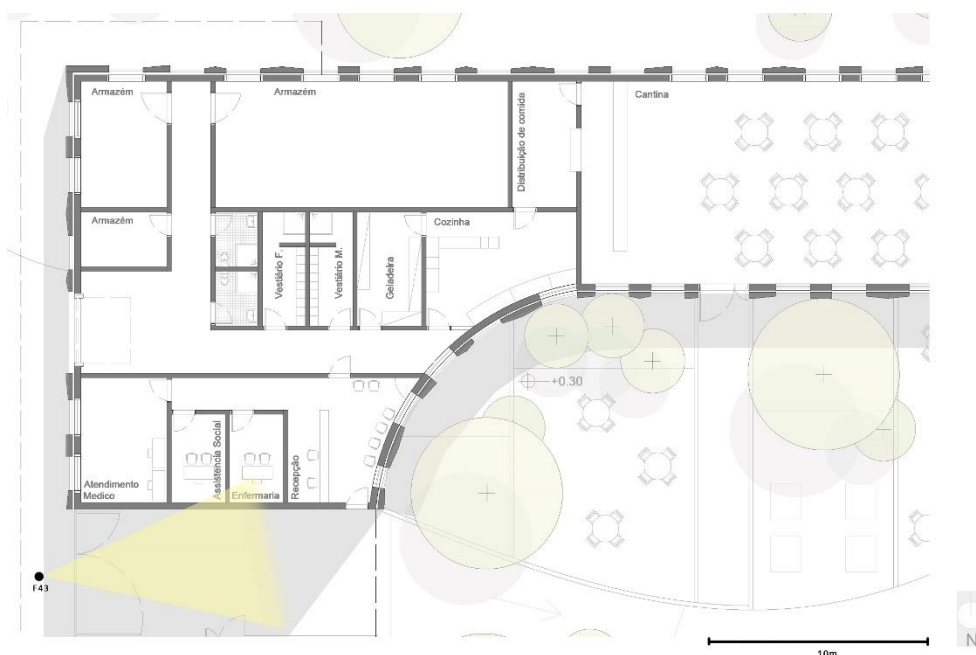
Planta do setor de aprendizagem com ponto de vista do desenho
